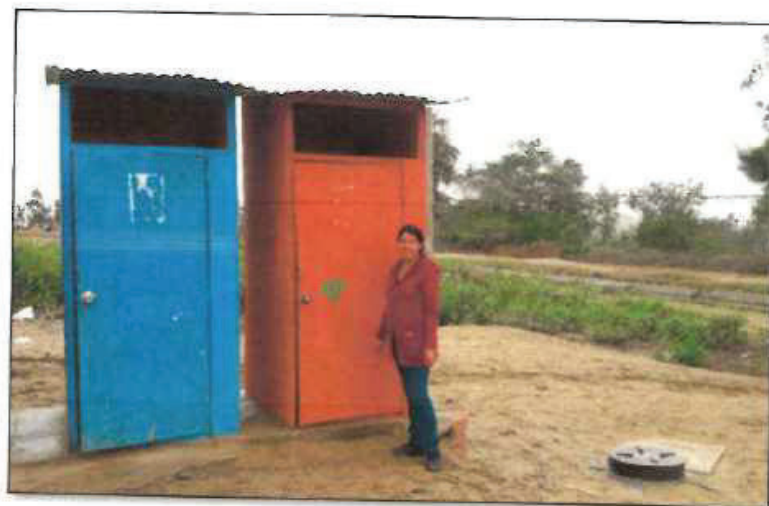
VISTA FRONTAL DE LOS SS.HH. CONSTRUIDOS
